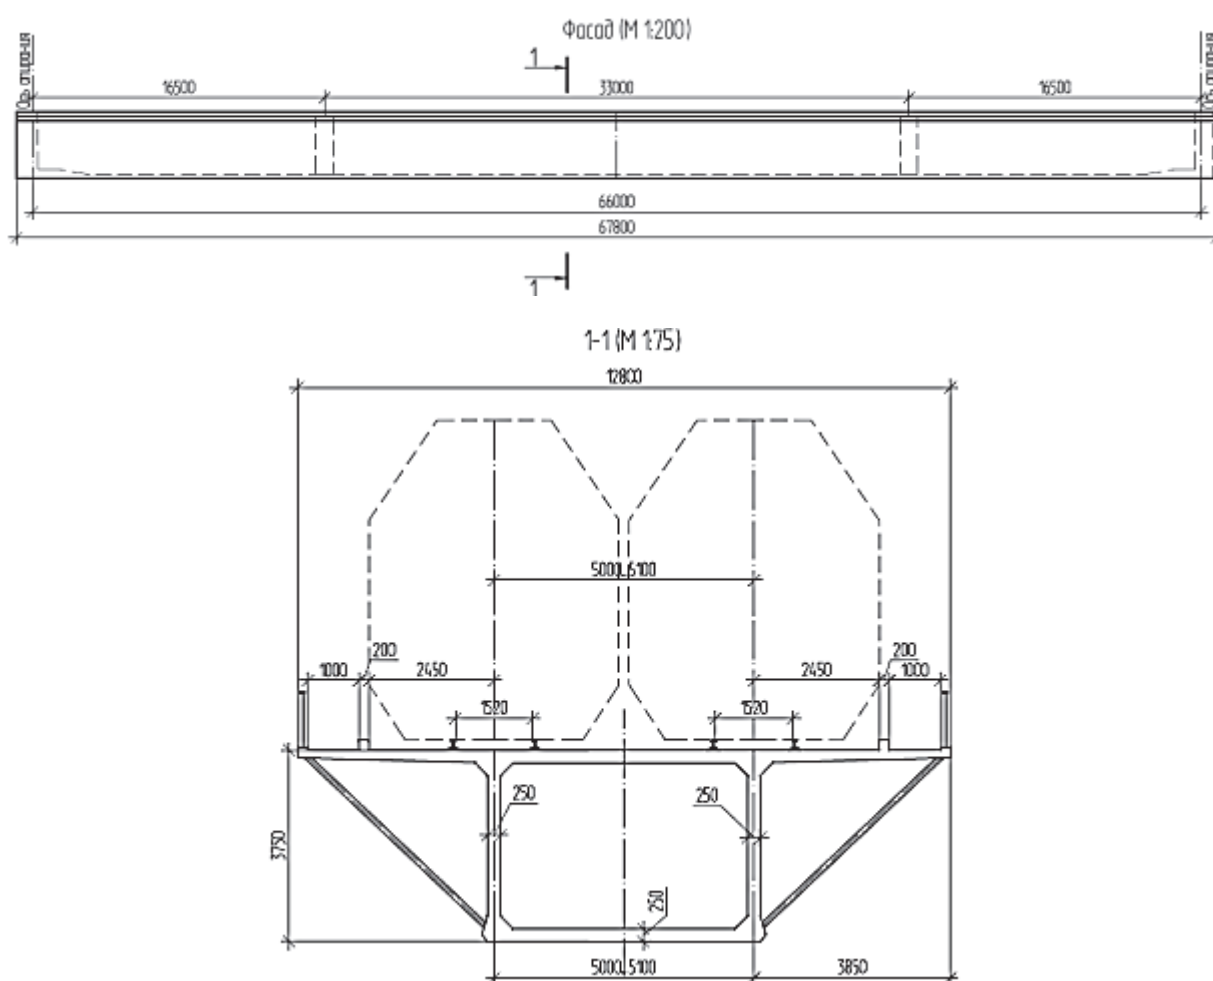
Фасад и поперечное сечение коробчатого железобетонного пролётного строения расчётным пролётом 66 м
